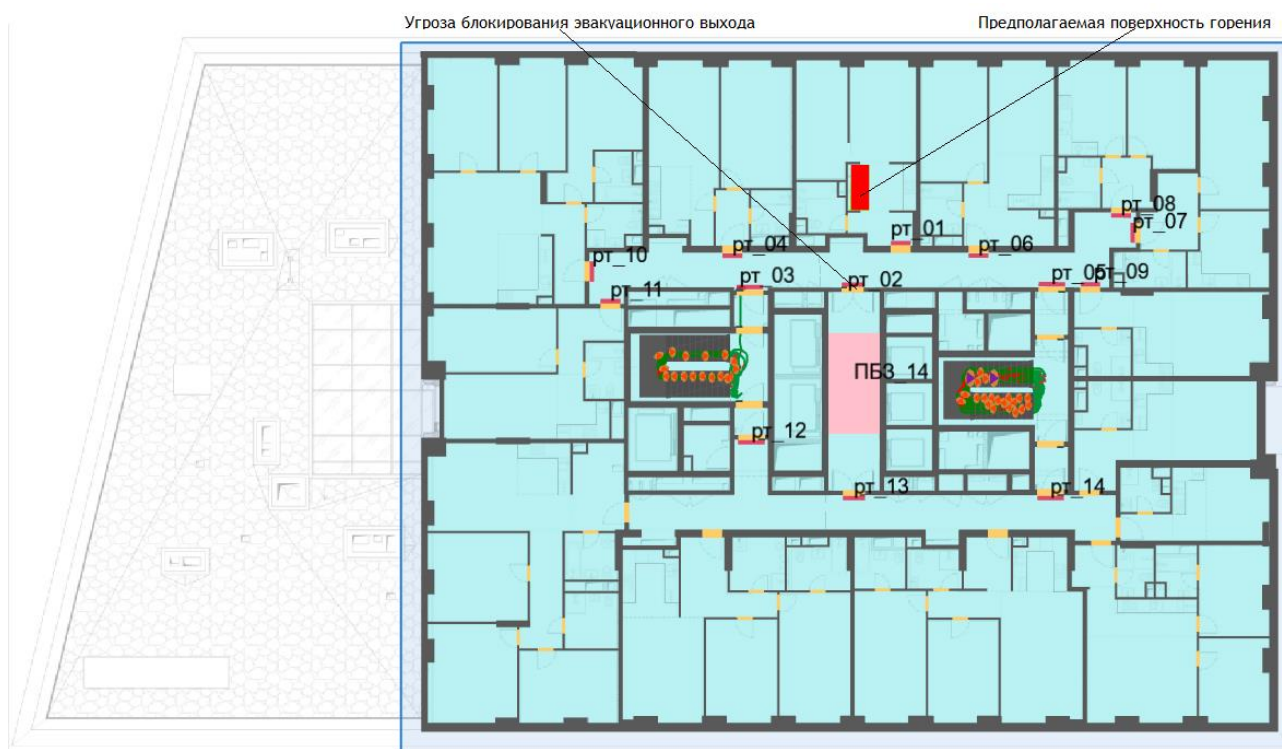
План 14-го этажа и нанесенная на него расчетная (принципиальная) схема эвакуации (расположение людей на момент полной эвакуации с этажа пожара – 2 мин. 26 сек.)
